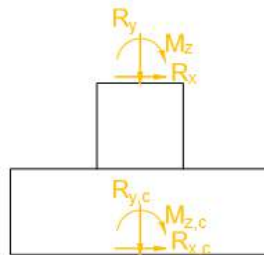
Reacciones en la base de la cimentación. Plano XY.
